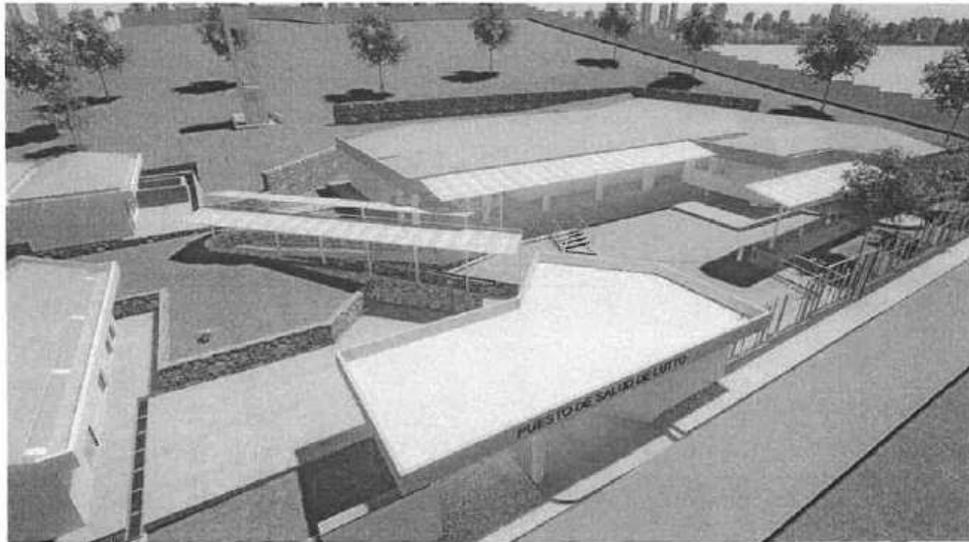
VISTA PANORAMICA FACHADA PRINCIPAL
